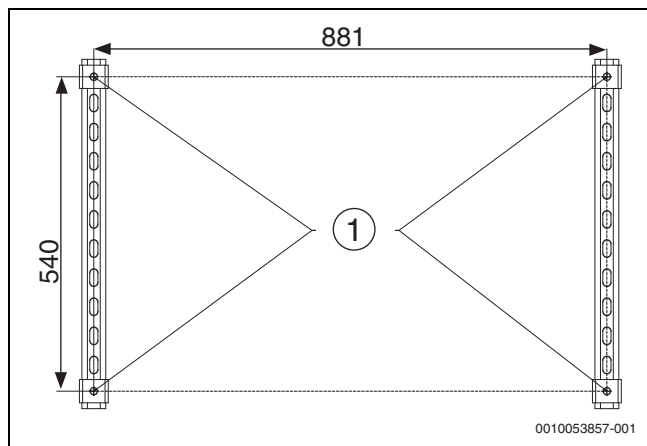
Mögliche Bohrpunkte Wandkonsole (Maße in mm)
